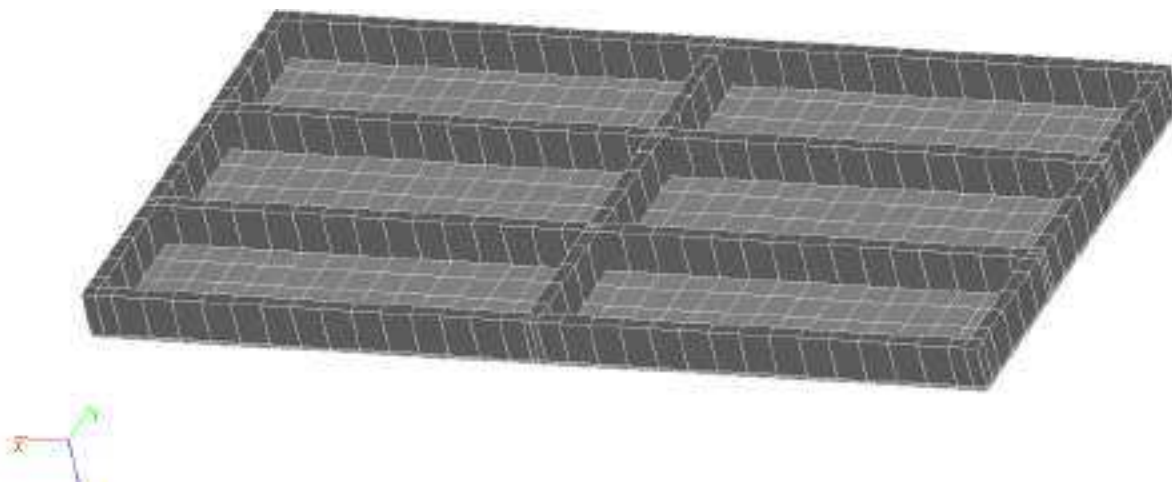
Расчетная схема плиты. Вид 2
